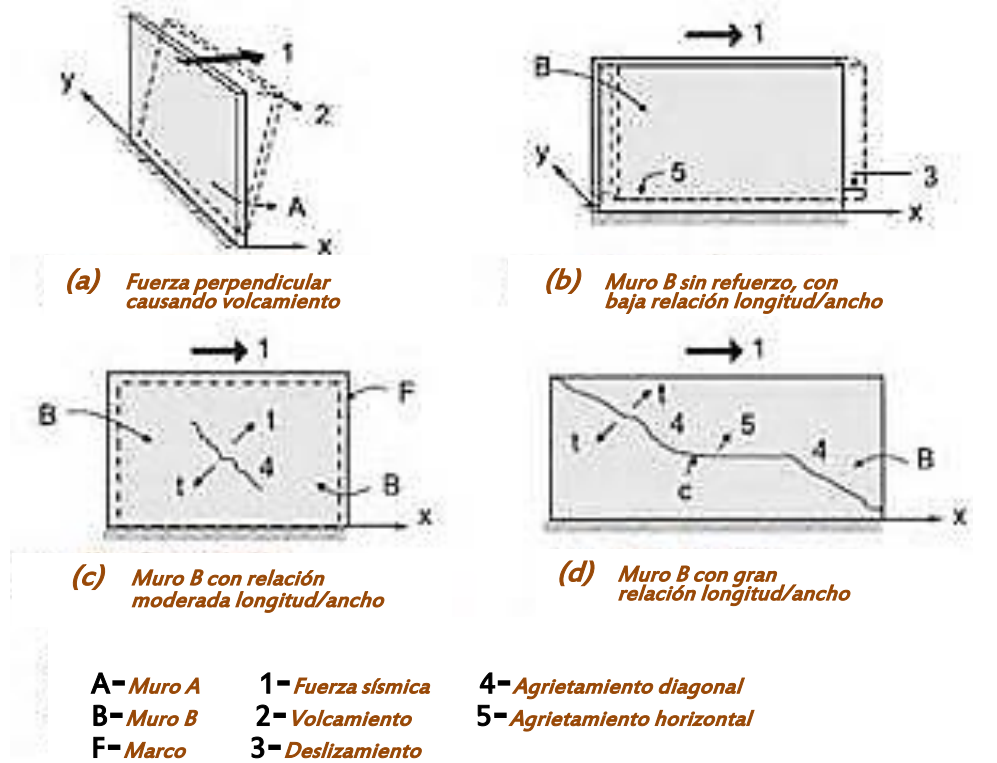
e.1-1.1) Ilustraciones de principales tipos de falla en muros de concreto, tanto en dirección paralela como transversal a su plano
